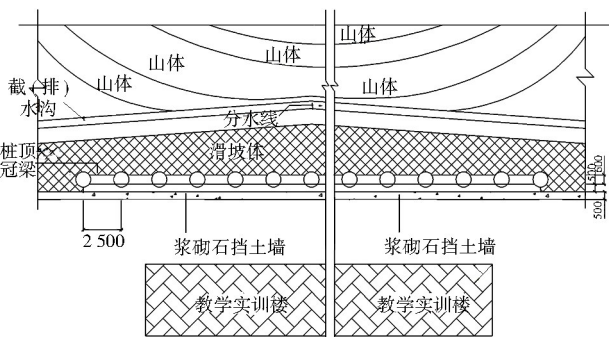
小型浅层滑坡防治工程平面布置示意(单位:mm)
